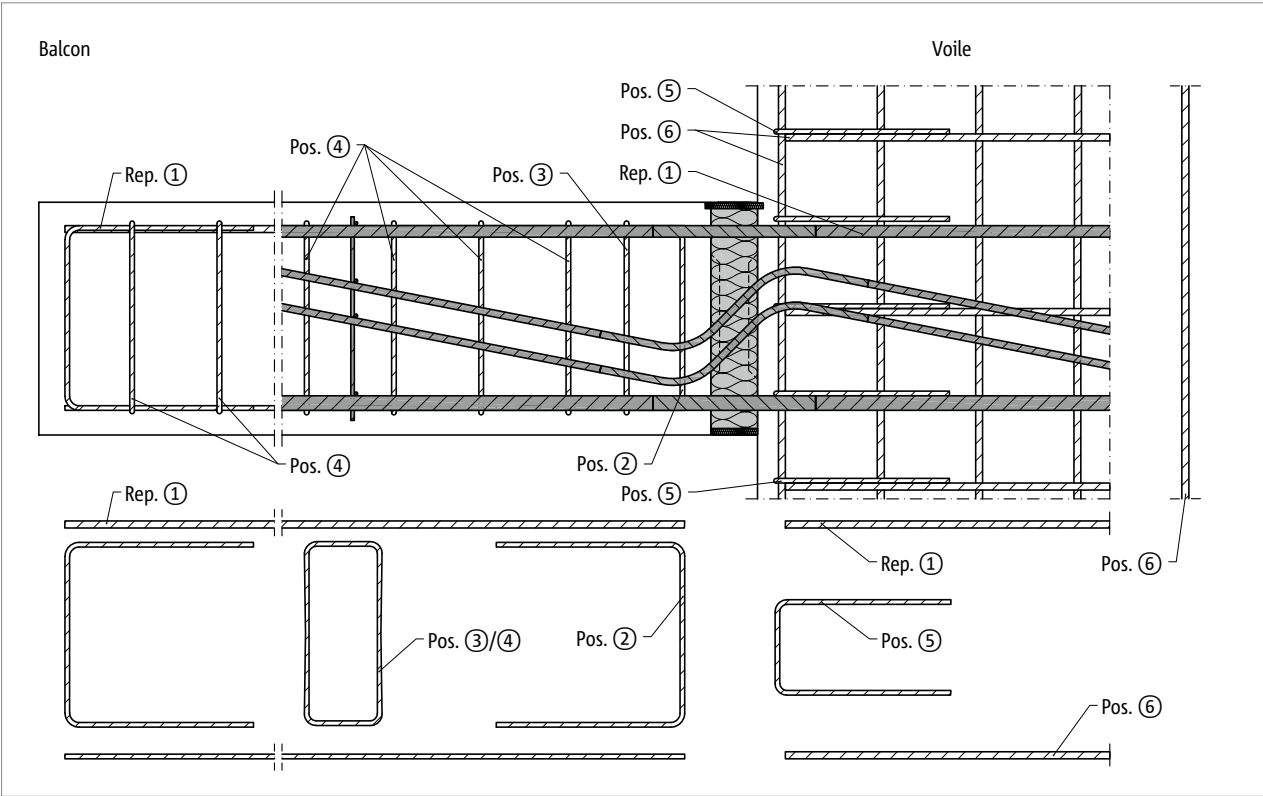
Schöck Isokorb® T Type B : Renforcement sur site (coupe)
